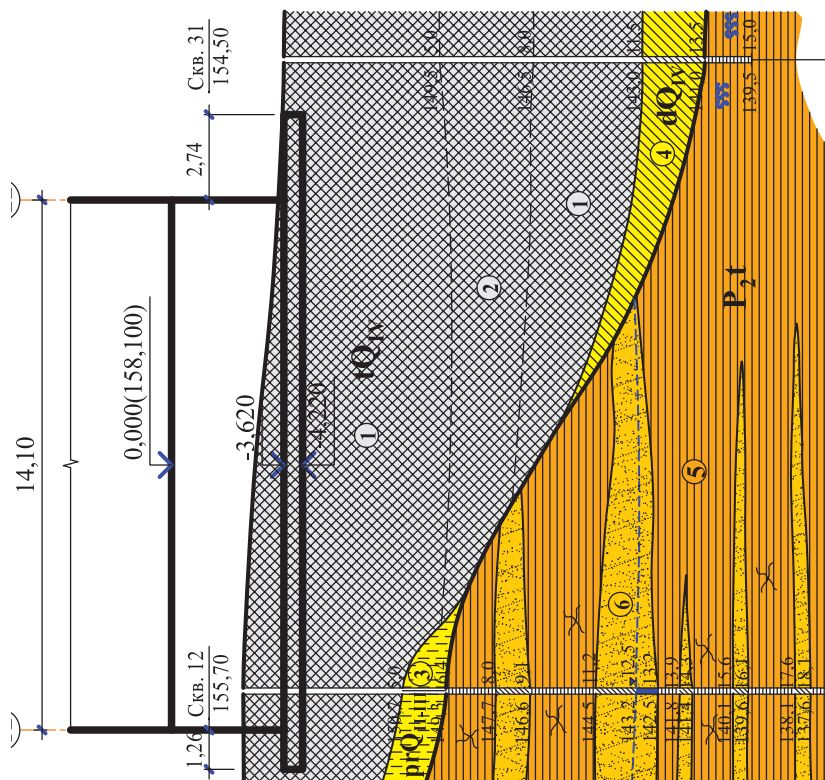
Инженерно-геологический разрез (поперек здания), иллюстрирующий геолого-литологическое строение грунтового основания под секцией № 2 дома № 15 на ул. Ломоносова
